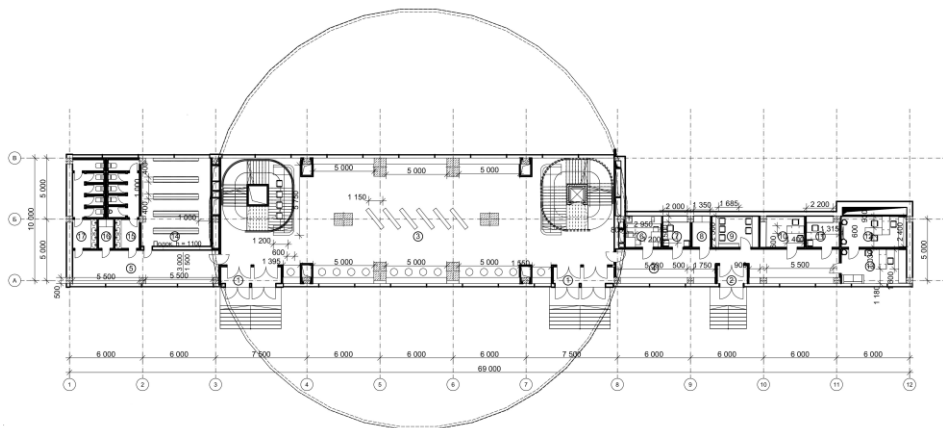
План на відмітці + 0,00 після перепланування з розстановкою меблів
